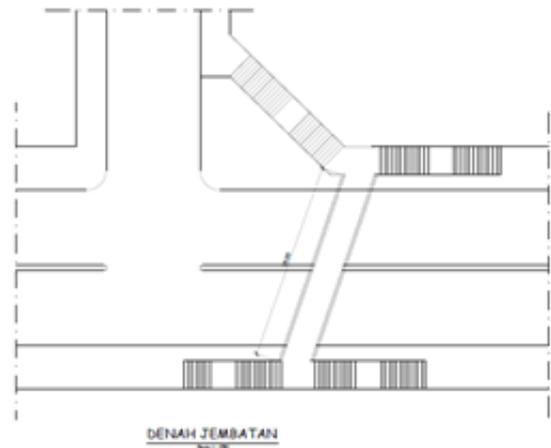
Segmen 4 rencana penempatan *vertical garden
